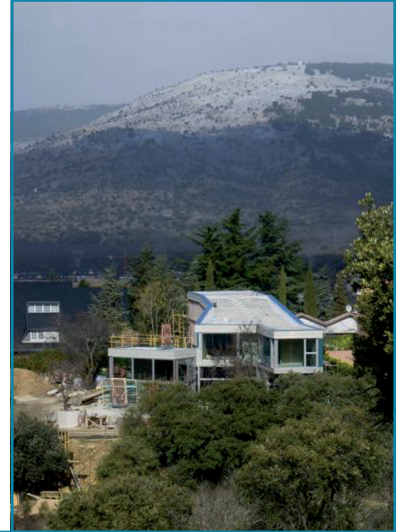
Arquitectas visitando la obra. Fotografía: M^a Teresa Hontoria.
